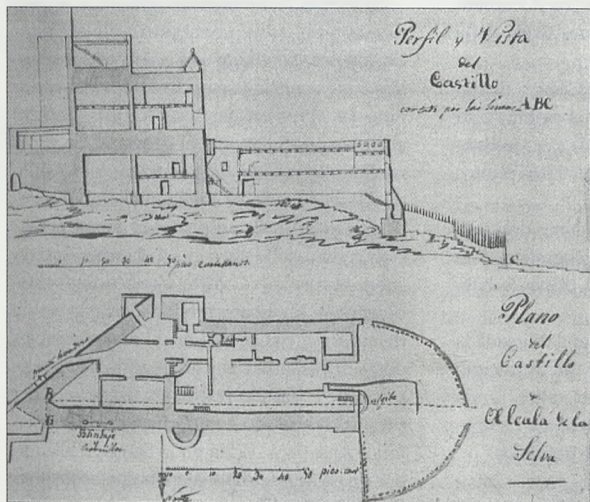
Planta y sección Antonio Sánchez Ossorio 1840
